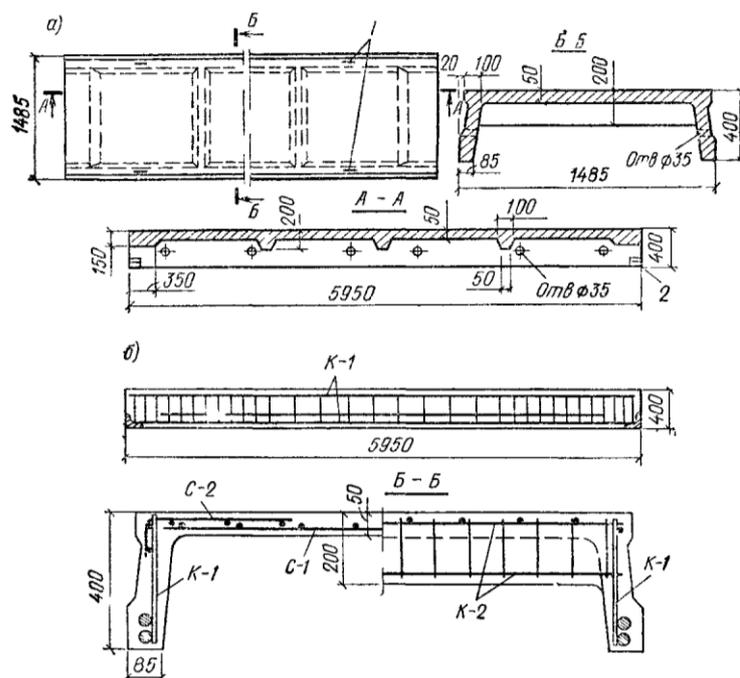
Конструкции сборных ребристых плит междуэтажных перекрытий промышленных зданий
